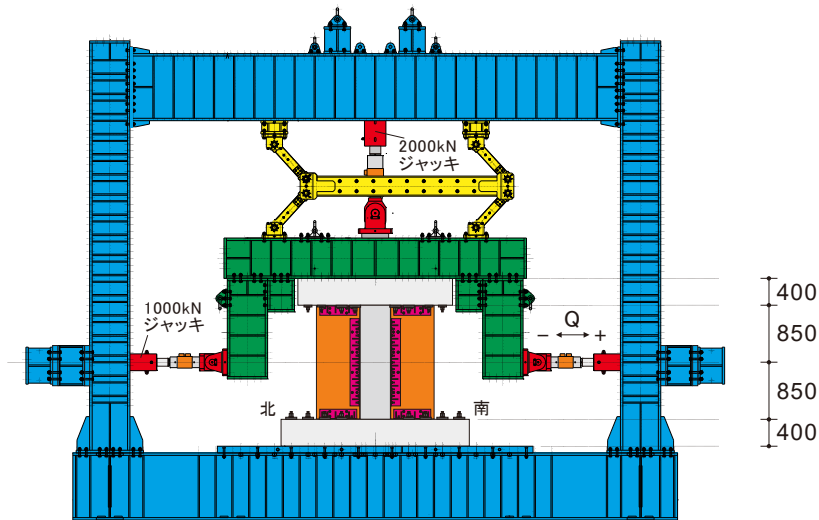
試験体 AD の加力装置図 (単位 : mm)
